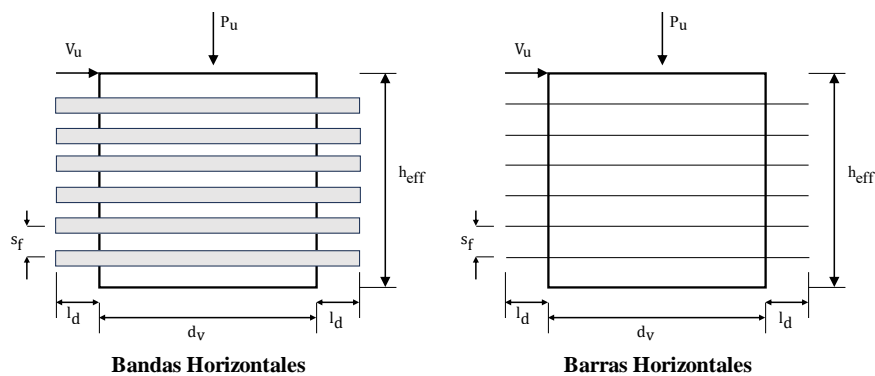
Refuerzo de muros de corte con polímeros reforzados con fibras. Extraído de (American Concrete
